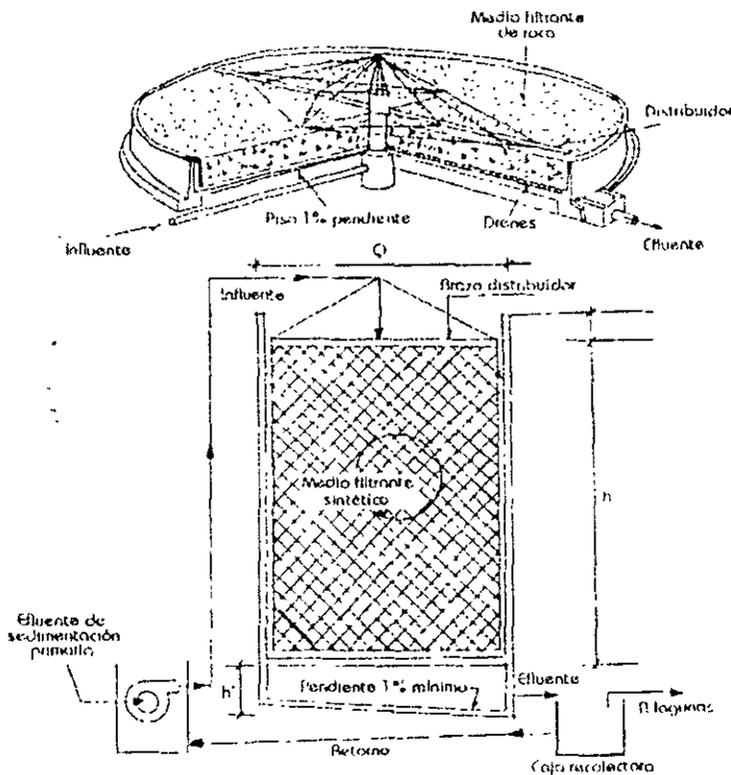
Filtros biológicos: a) horizontal con piedra, b) vertical con medio sintéticos
